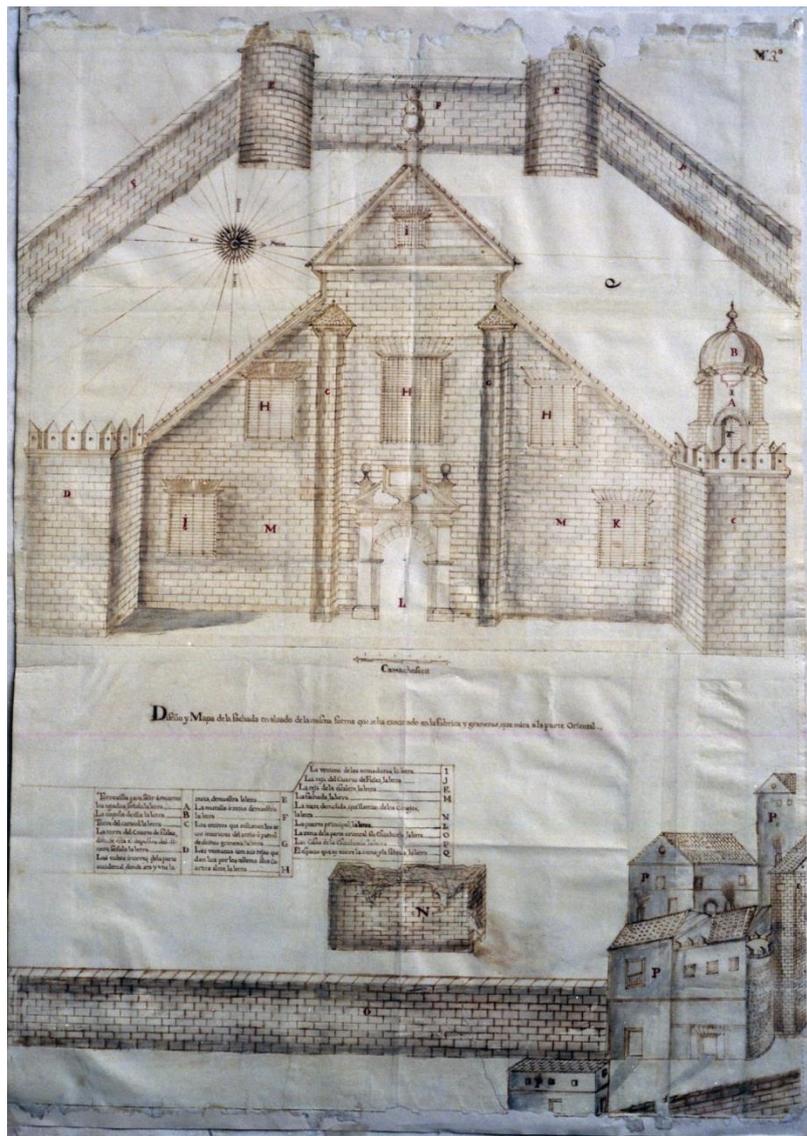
Plano N°3. Diseño y Mapa de la fachada en alzado del alhorí del Castillo¹⁸⁸
